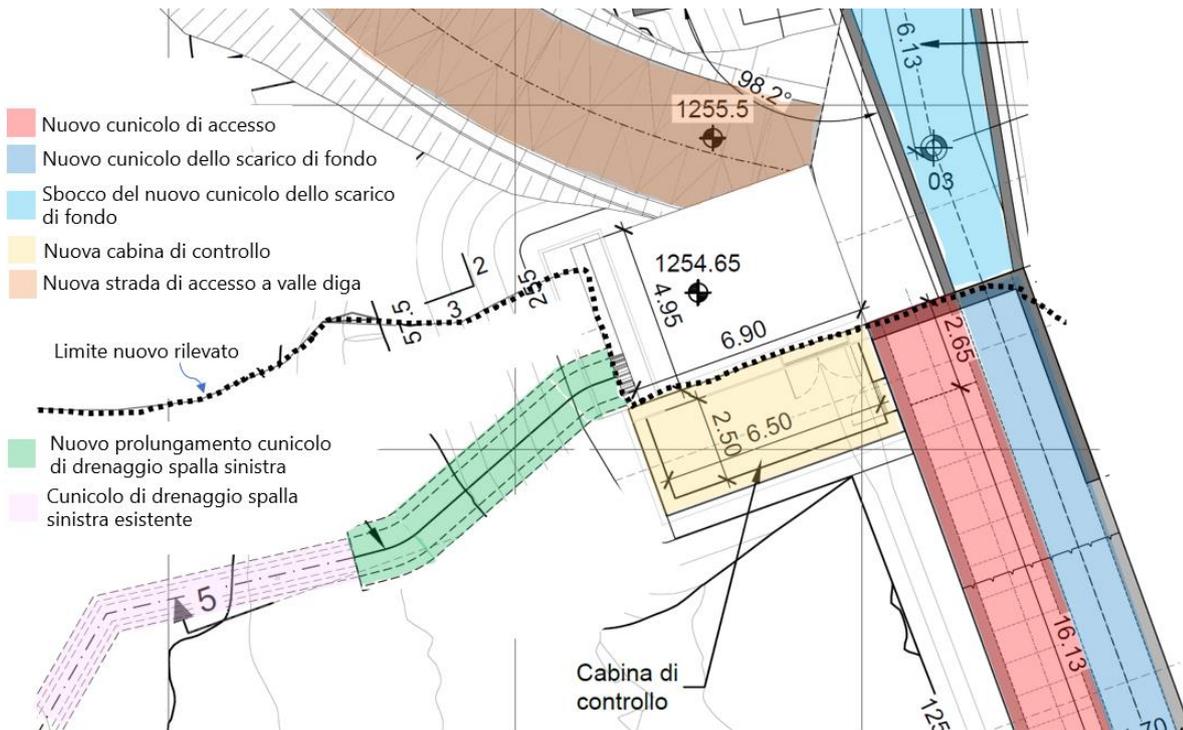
prolungamento del cunicolo di drenaggio della spalla sinistra: pianta
